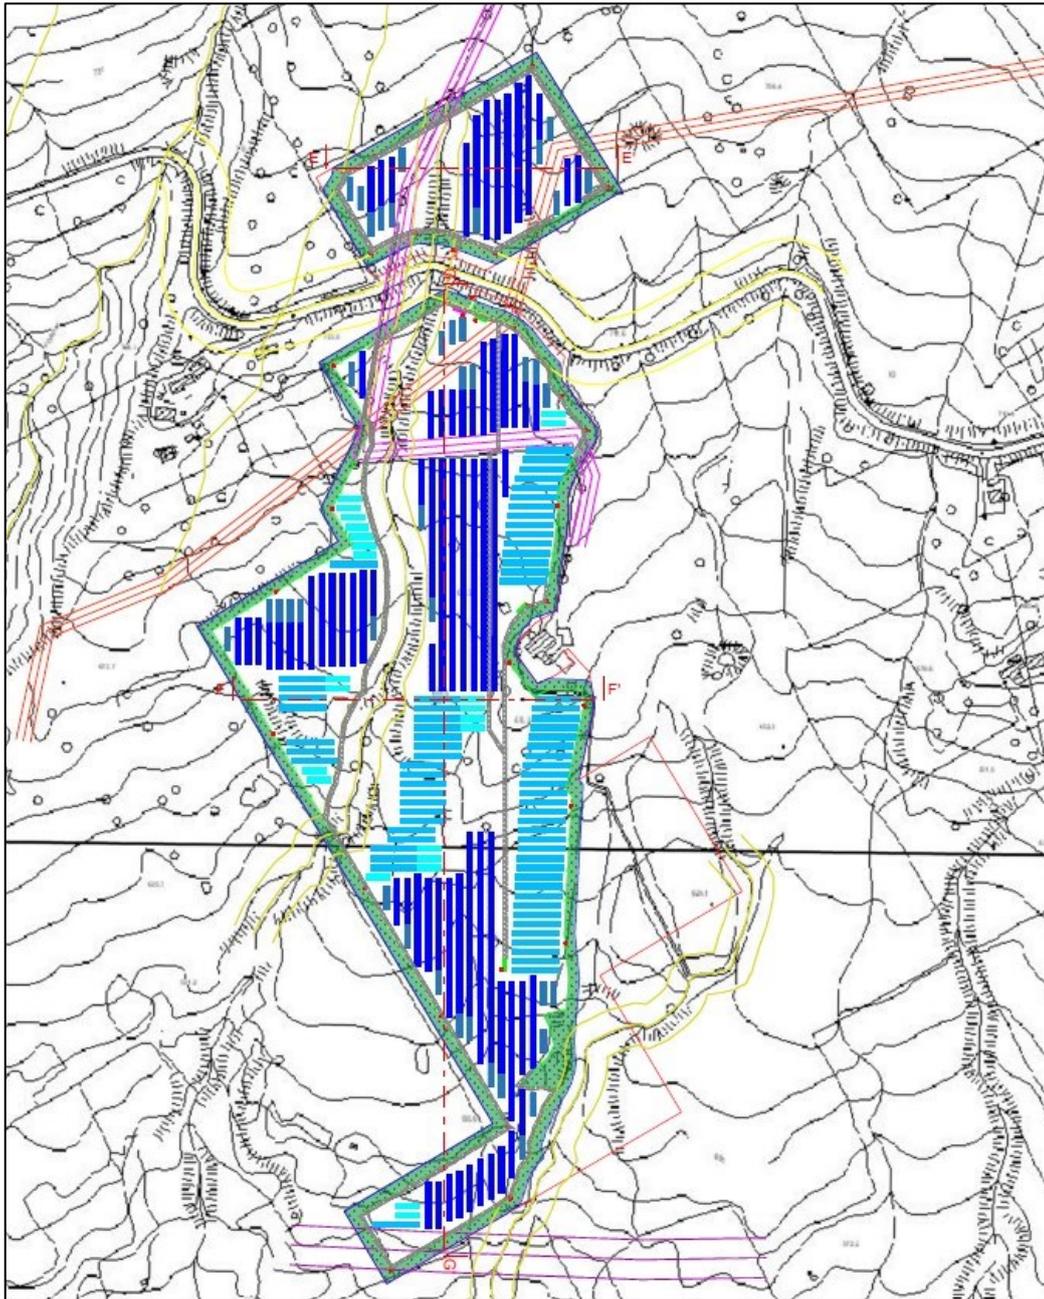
Planimetria e indicazioni delle sezioni – sottocampo 6
